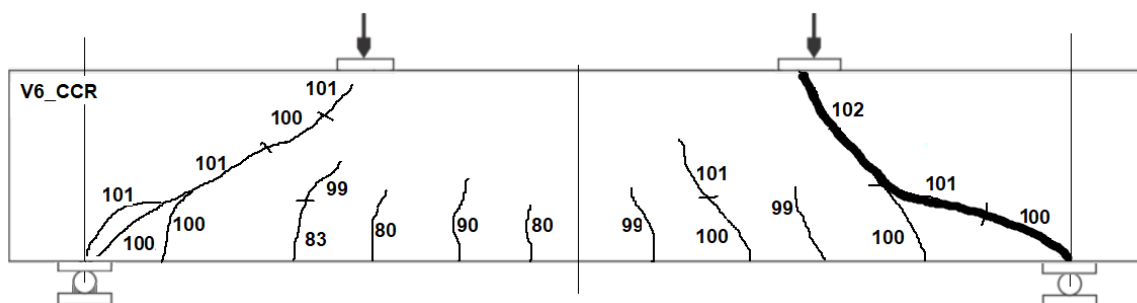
Esquema de fissuração da Viga 6_CCR.
